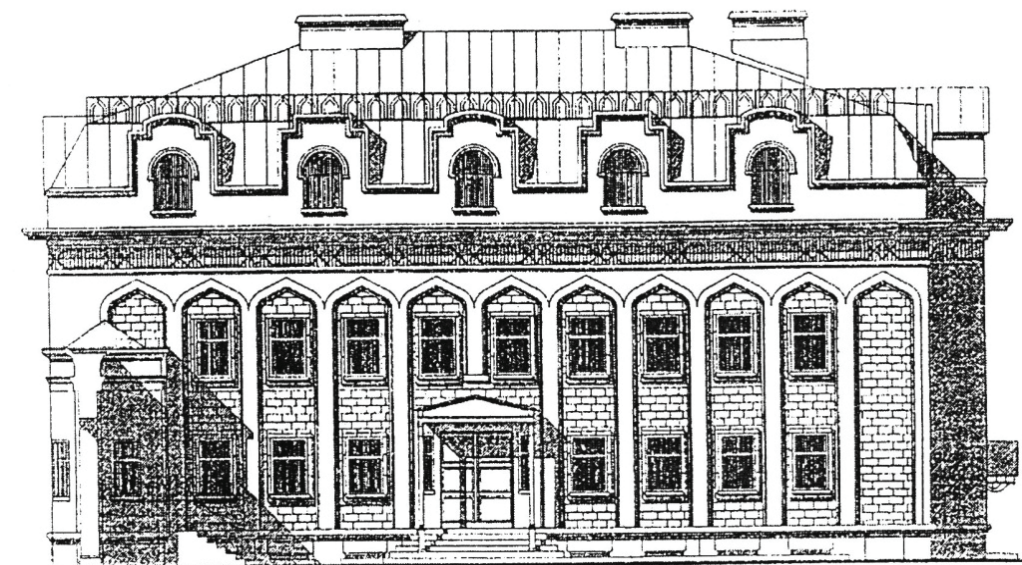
Отделка фасада служебного здания посольства Ирана плиткой из натурального камня
